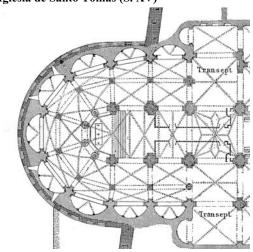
Ávila. Catedral, detalle de la planta del ábside y crucero (Street [1865] 1926)
